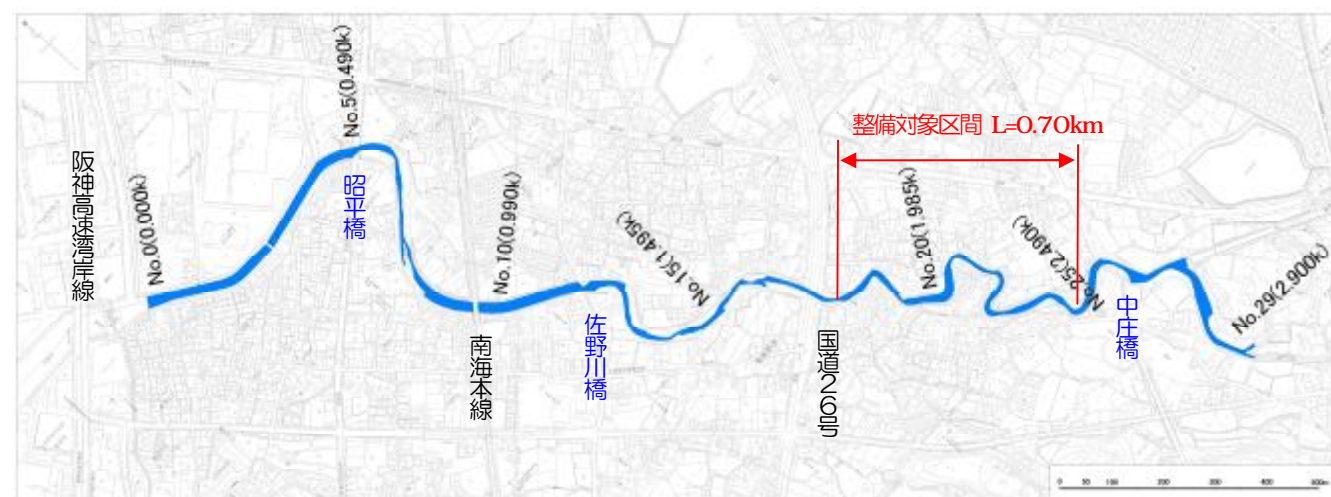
整備対象区間平面図（国道26号～中庄橋）
